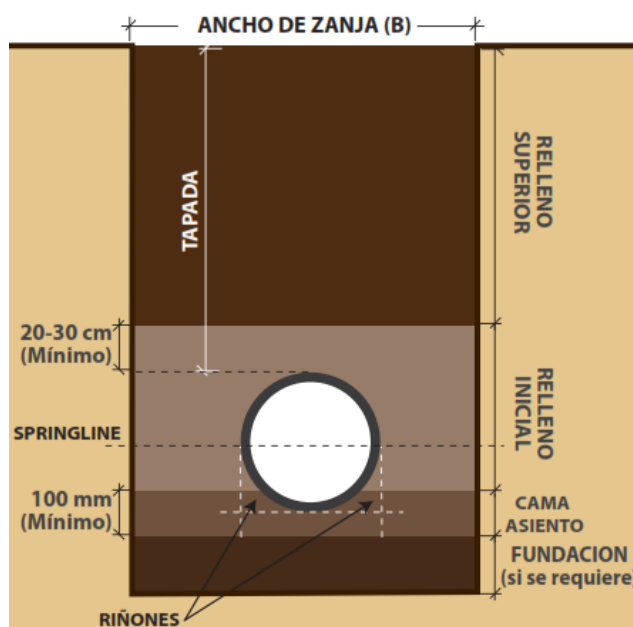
Zanja tipo para tuberías flexibles (Manual técnico Amanco. Año 2014).
